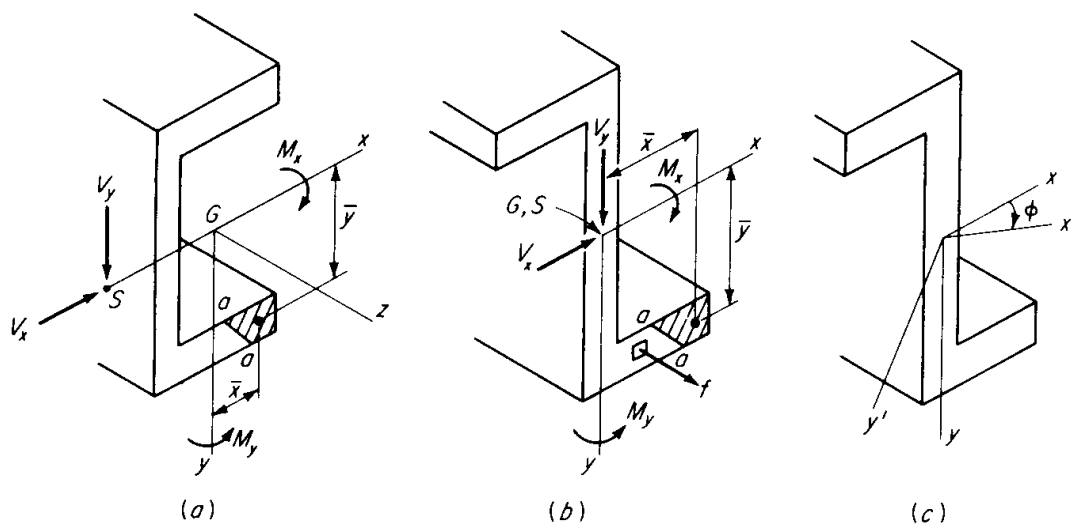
Flexión biaxial en secciones asimétricas (Ref. 2)
